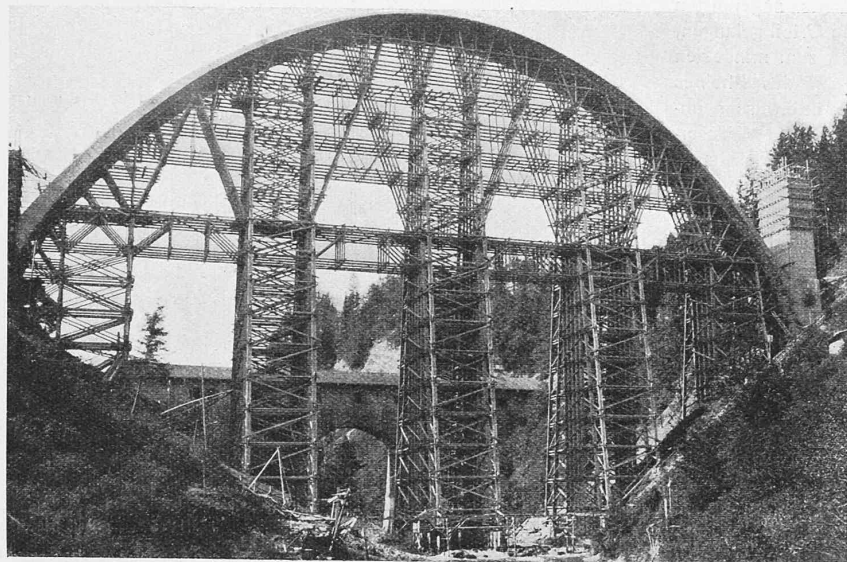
Lehrgerüst der Hundwilertobel-Brücke, Entwurf und Ausführung Ed. Züblin & Cie. (Zürich).
